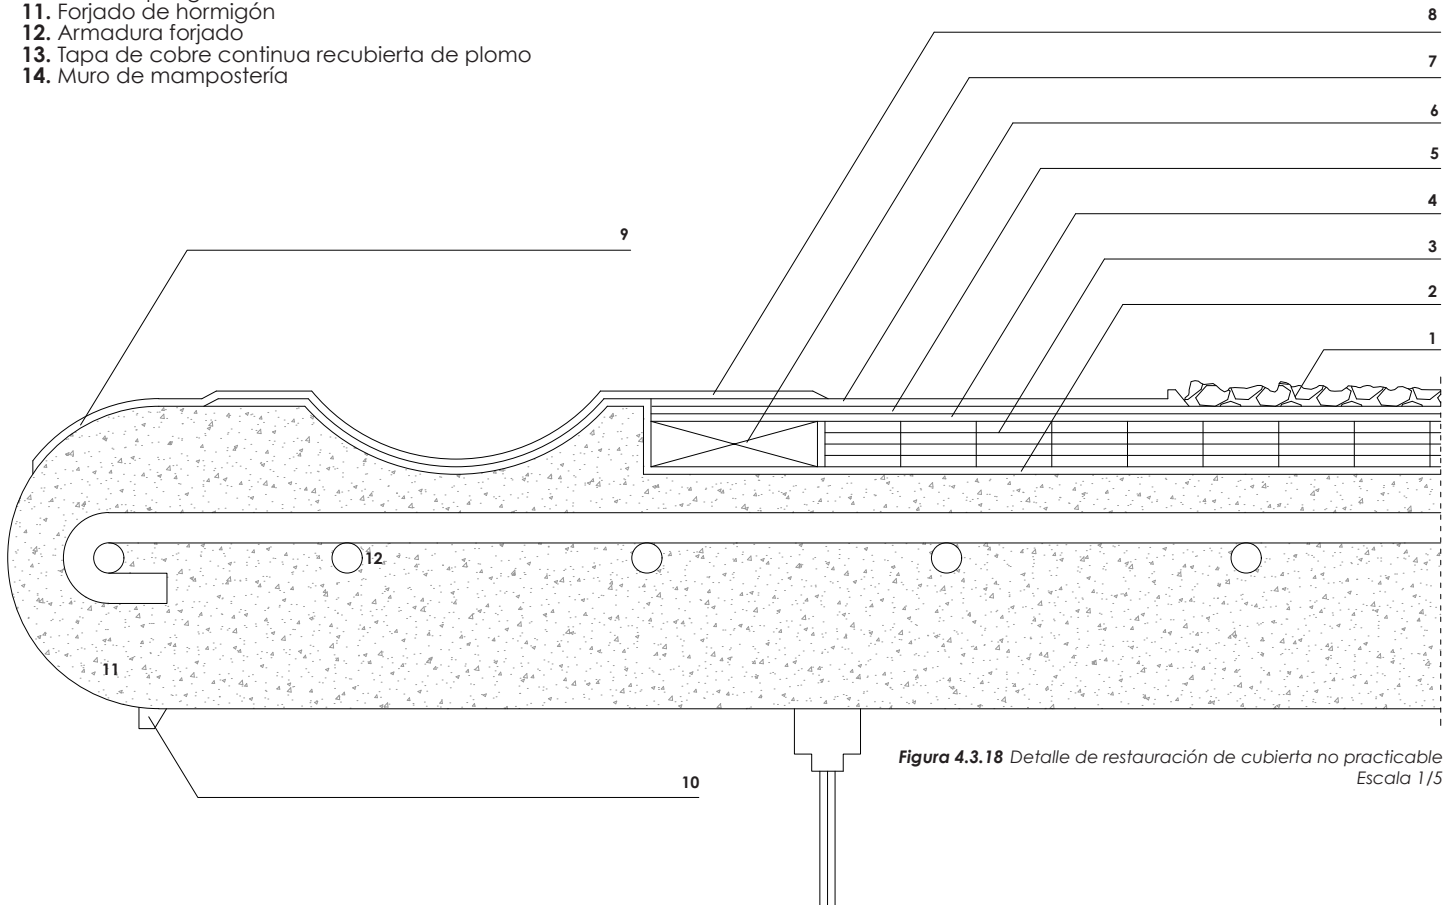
Detalle de restauración de cubierta no practicable
